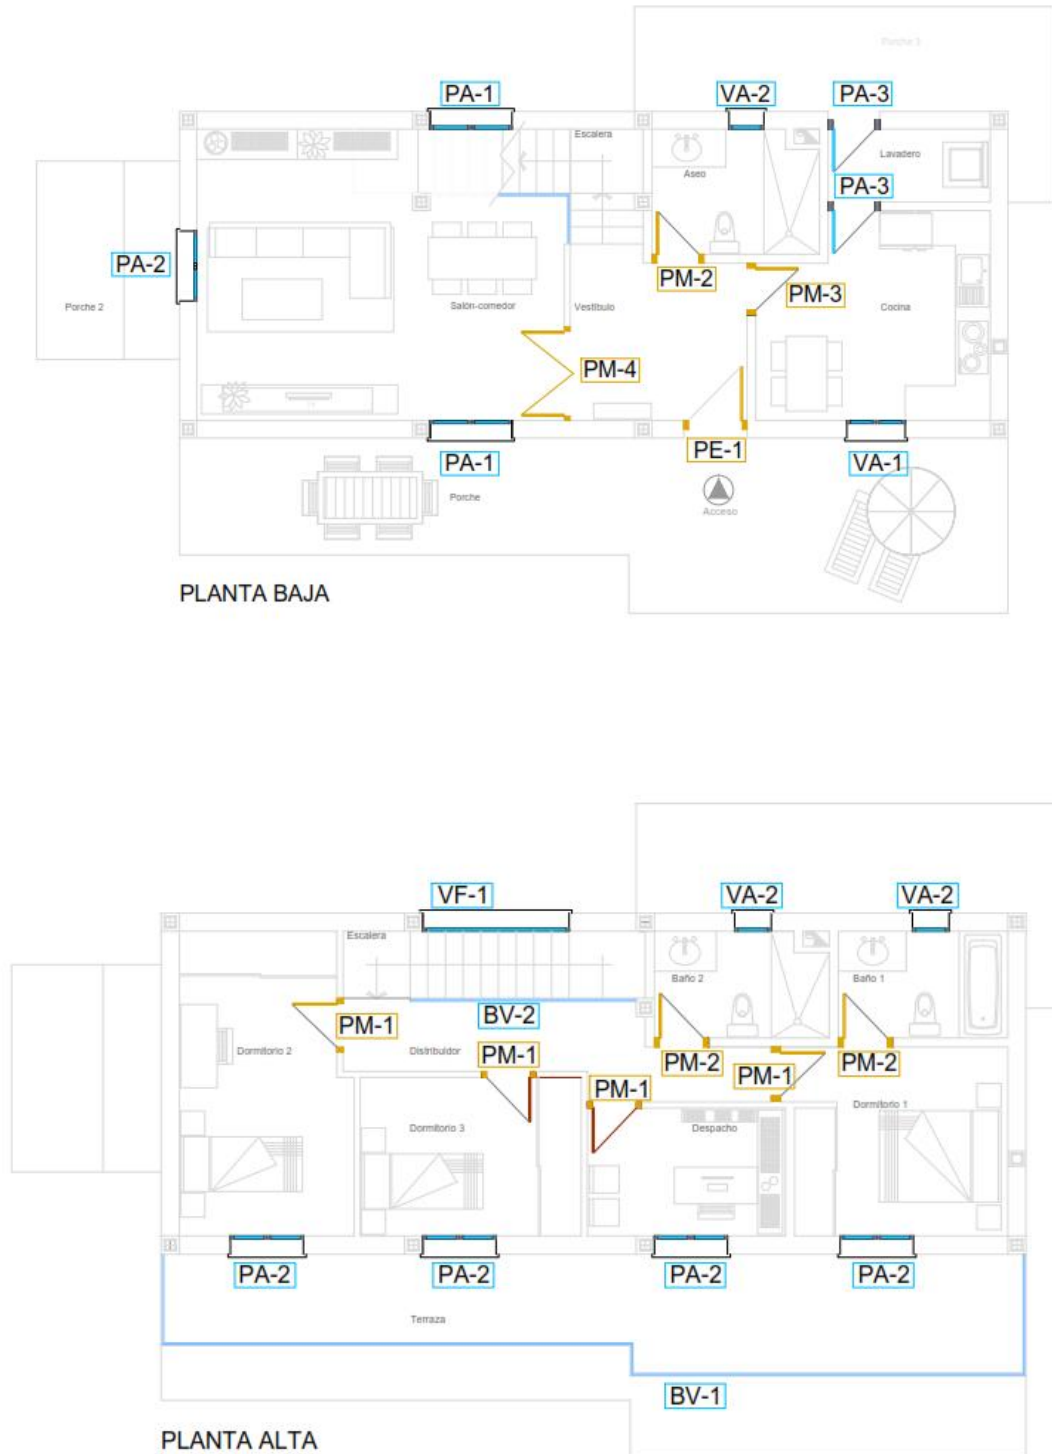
Carpintería exterior e interior del inmueble, barandilla para escalera y terraza.
